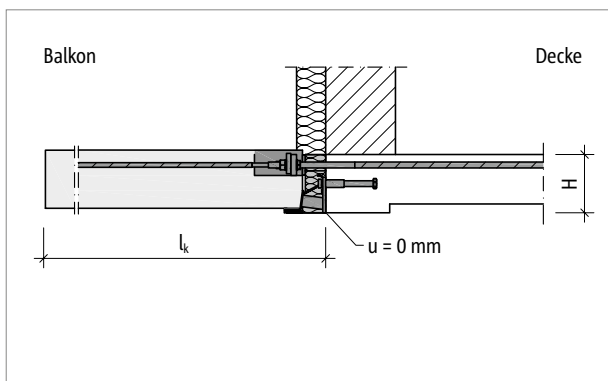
Schöck Isokorb® IQ Typ K-B: Schnitt
